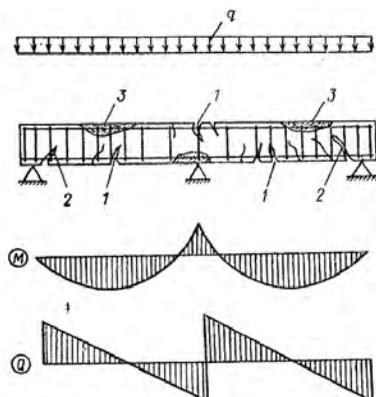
Характерные трещины в изгибаемых железобетонных элементах, работающих по балочной схеме:
